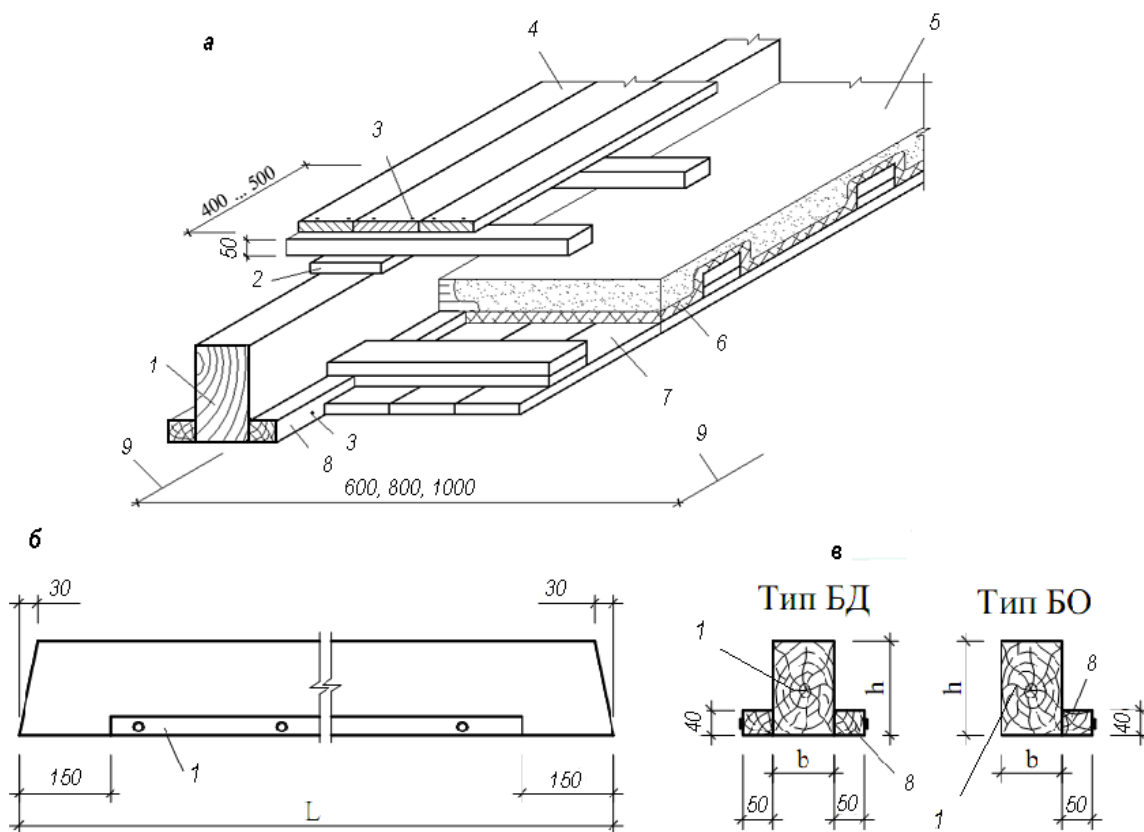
Конструктивна схема перекриття по дерев'яних балках: а – загальний вигляд; б – загальний вигляд дерев'яної балки з черепними брусками; в – поперечні перерізи балок; 1 – дерев'яна брускова балка одинарна із суцільної деревини; 2 – пружна прокладка; 3 – цвях; 4 – дощата підлога по лагах; 5 – прожарений пісок 60...80 мм; 6 – глиняне змазування 20...30 мм; 7 – дерев'яний щитовий накат; 8 – черепний брусок; 9 – вісь балки
